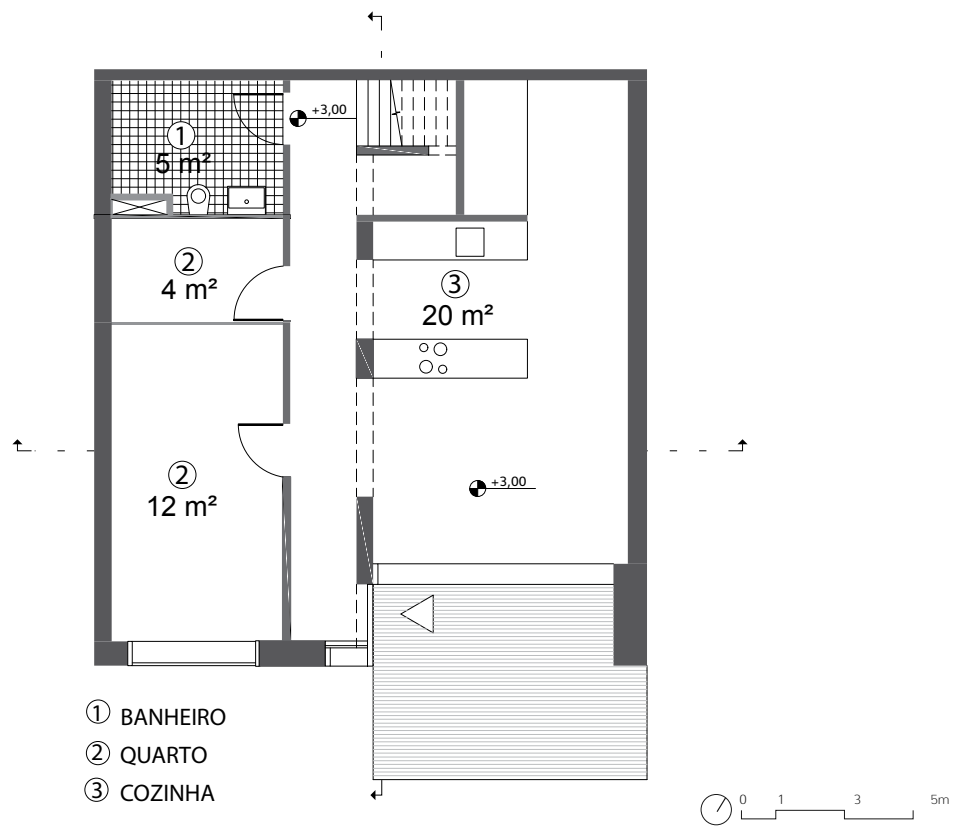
Planta baixa primeiro pavimento - *Gardenhouse*.
